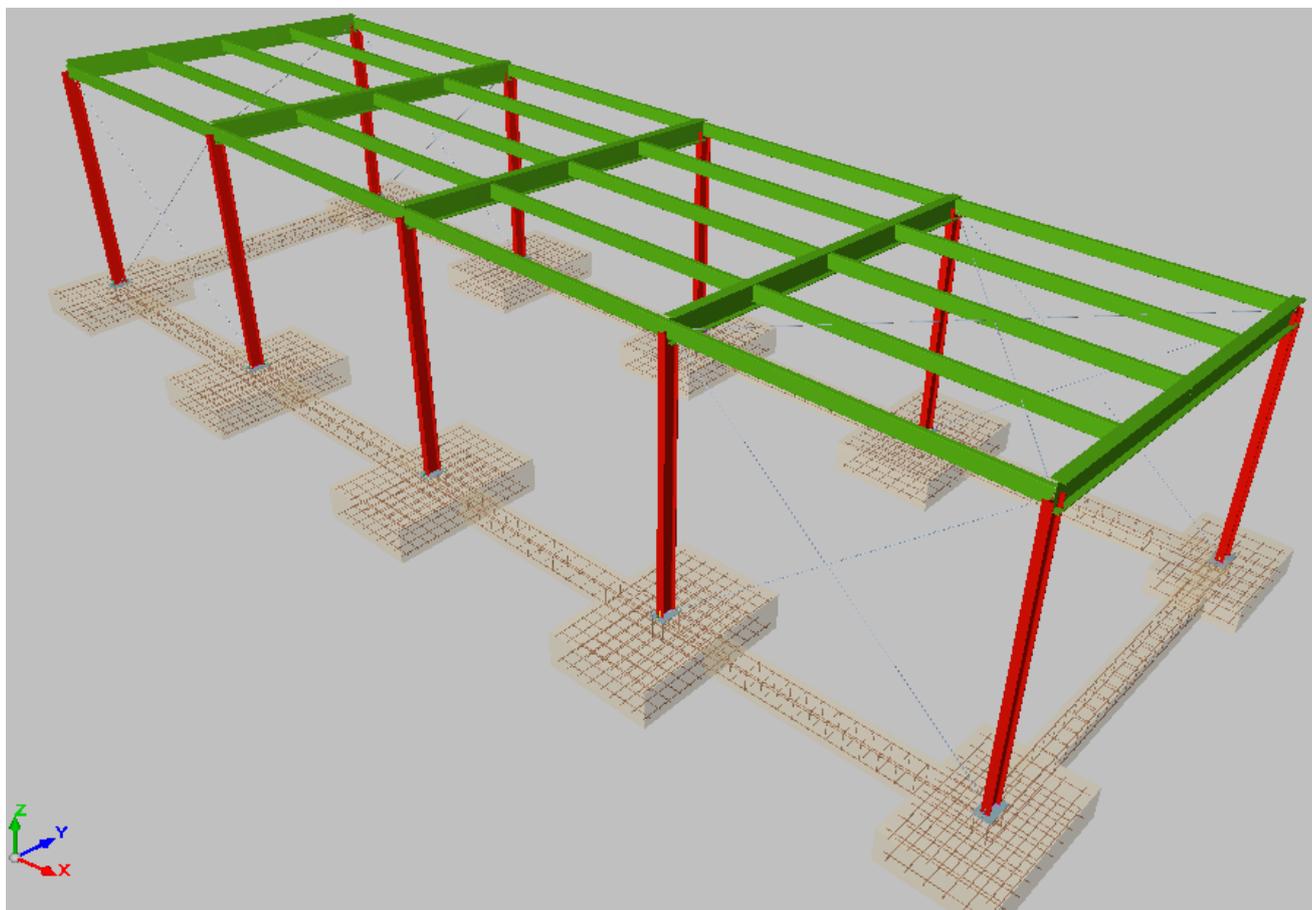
Imagen en 3D de la estructura metálica y las zapatas.
